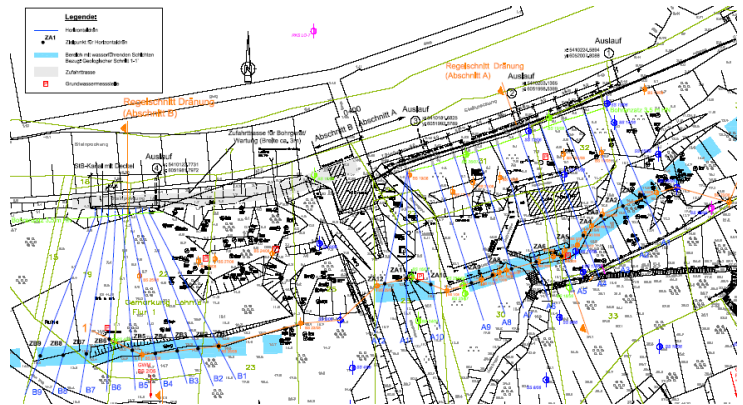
Lageplan mit den geplanten Horizontalbohrungen
